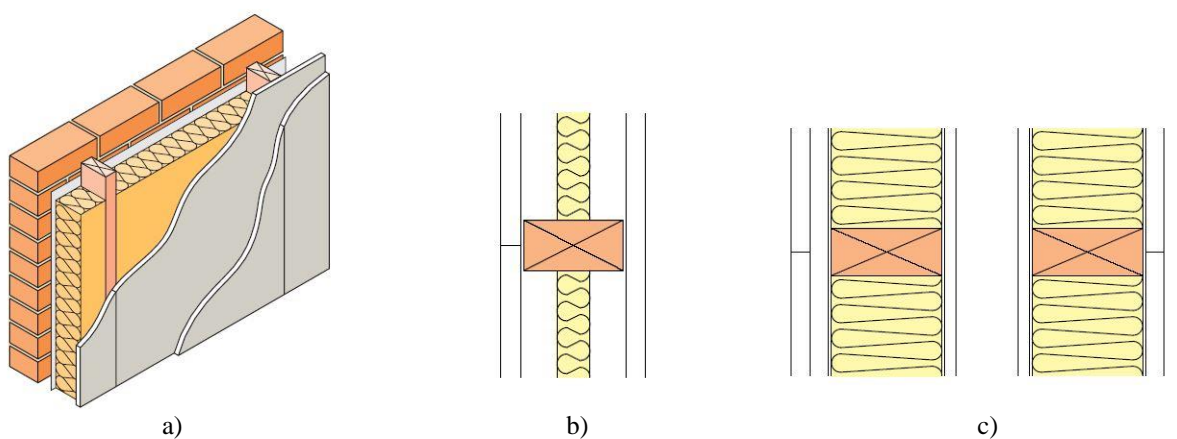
Secções típicas de paredes no sistema Timber Frame: a) parede externa; b) parede interna; c) parede partilhada (*party wall*) [58]
